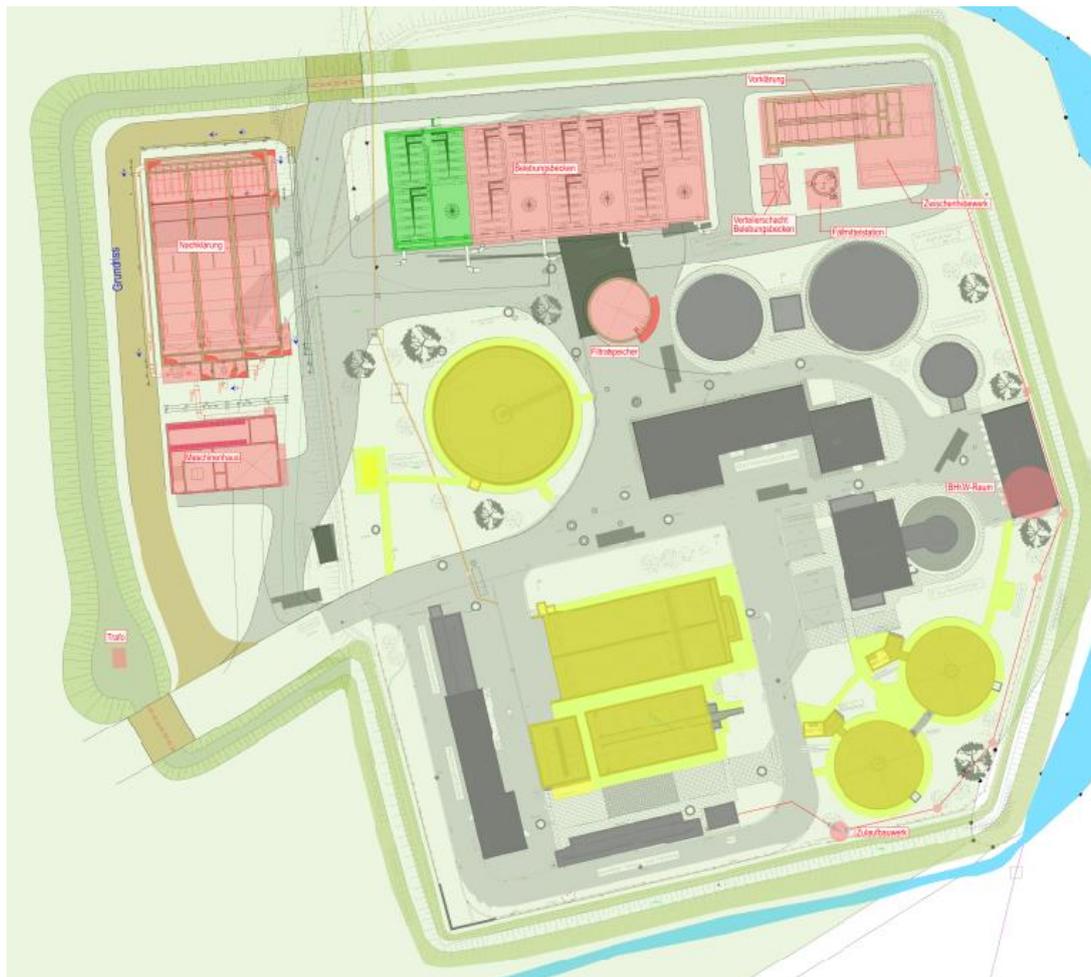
Ausschnitt Kläranlage Gundelfingen mit geplanten Gebäuden, Planstand: Vorabzug April 2022
